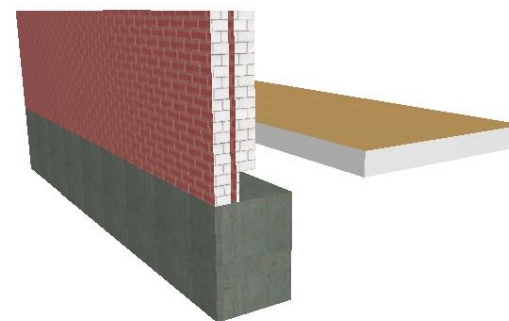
Вузол перекриття-фундамент-багатошарова стіна побудований в 3D
